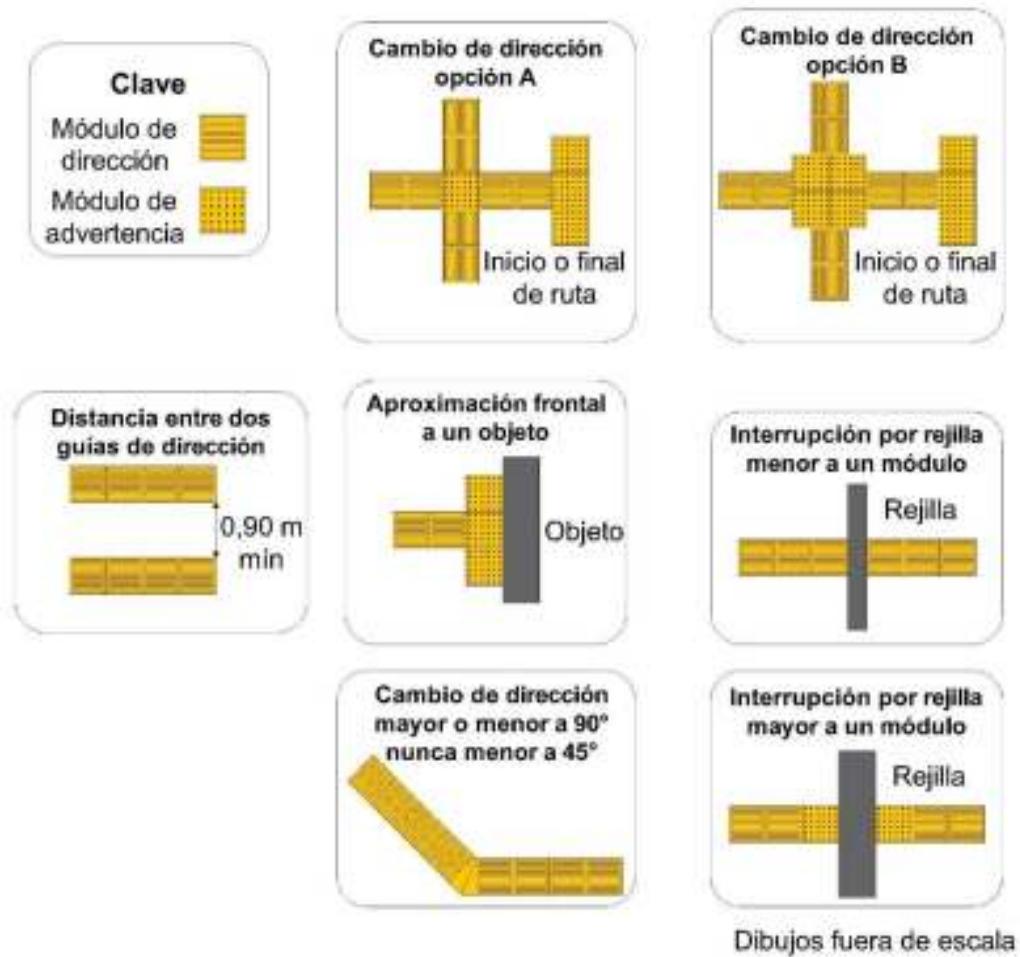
27 Aplicación de ruta con pavimento táctil
